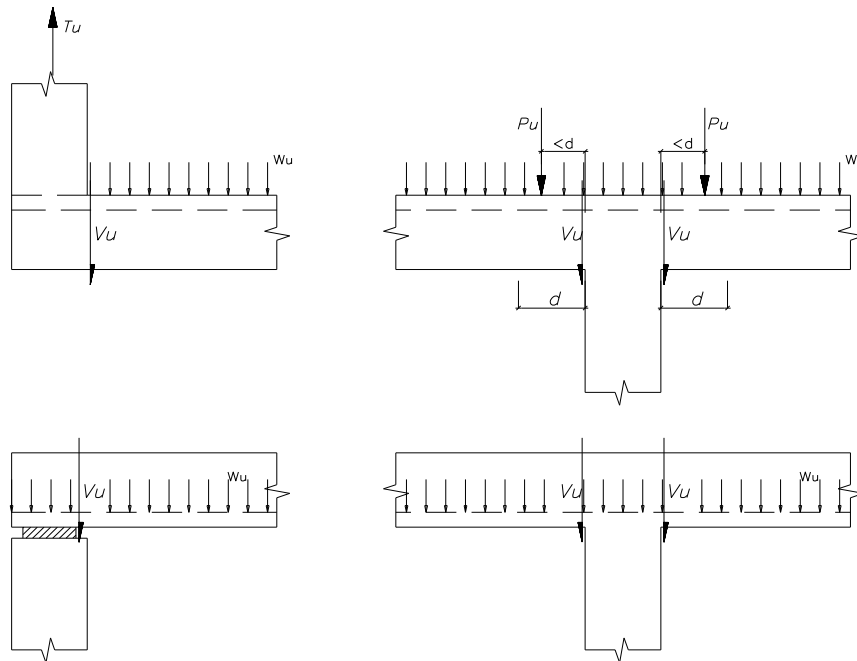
b Condiciones de apoyo y de aplicación de las cargas externas en las cuales no se puede reducir la fuerza V_u de diseño.
